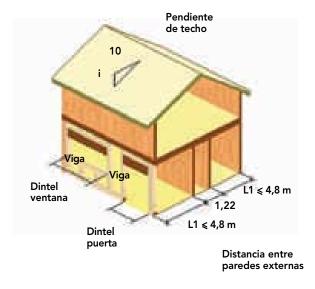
Dimensionamiento de dinteles de paredes exteriores de primer nivel en viviendas de dos pisos.
